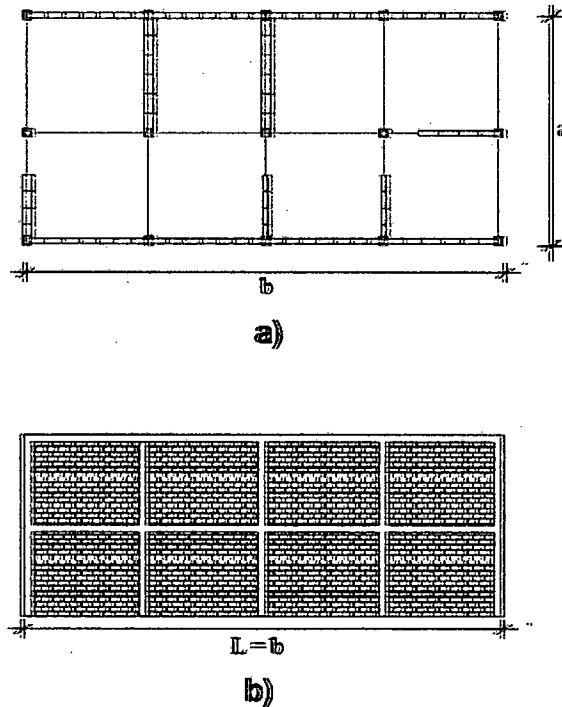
Tipo de muro real de albañilería confinada, representado en los METP's mediante muros con espesores teóricos máximos. a) Vista en planta de los muros de una edificación de albañilería confinada; b) Elevación del muro perimetral largo orientado en la dirección del eje X.
